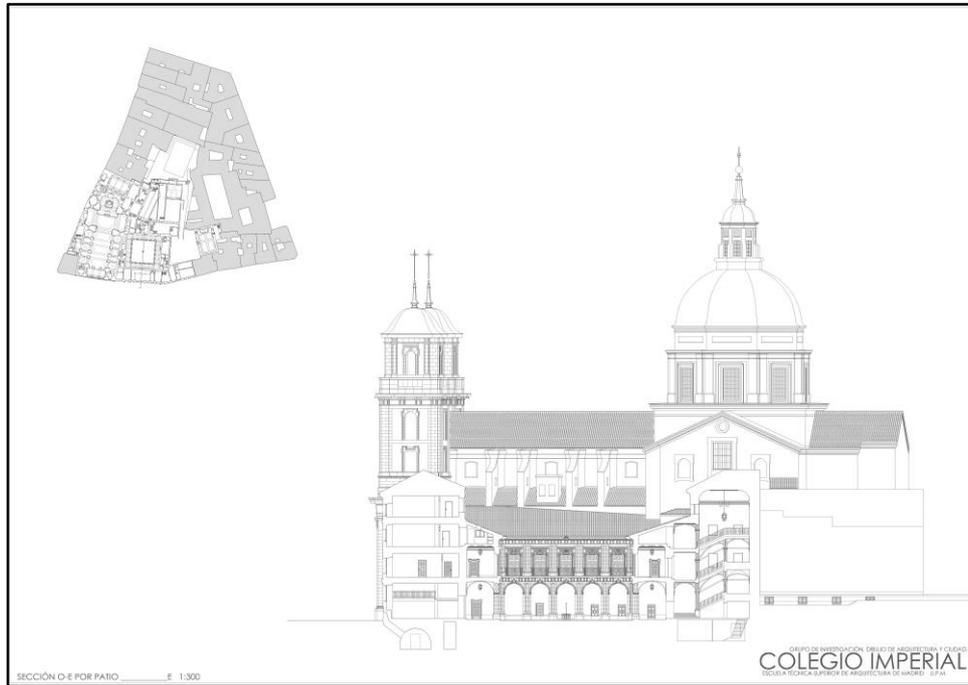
Concatedral e Instituto de San Isidro: sección y alzado longitudinal por el eje del claustro.
